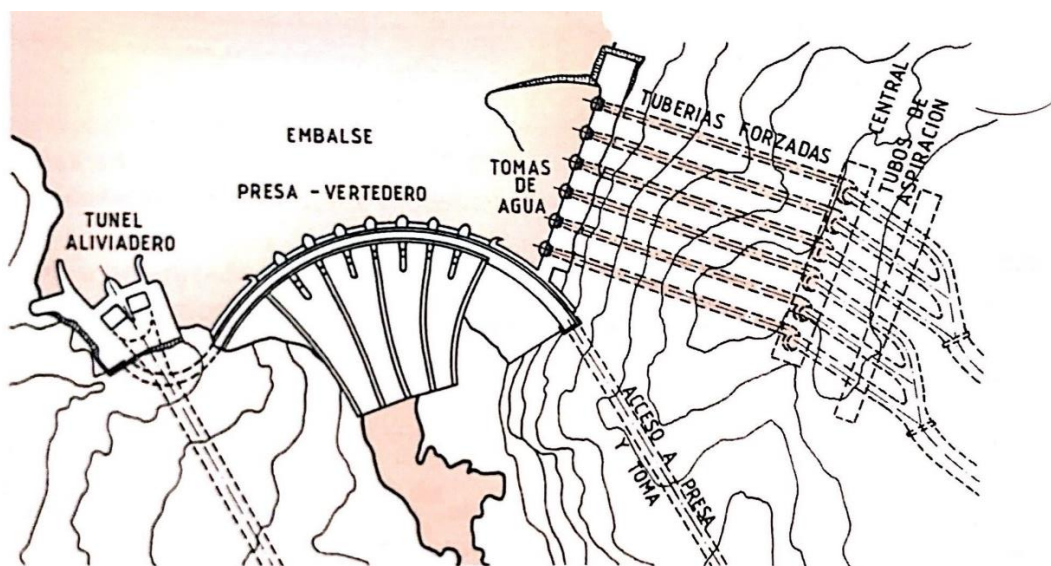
Representación en planta de central apartada con tomas laterales. [19]
